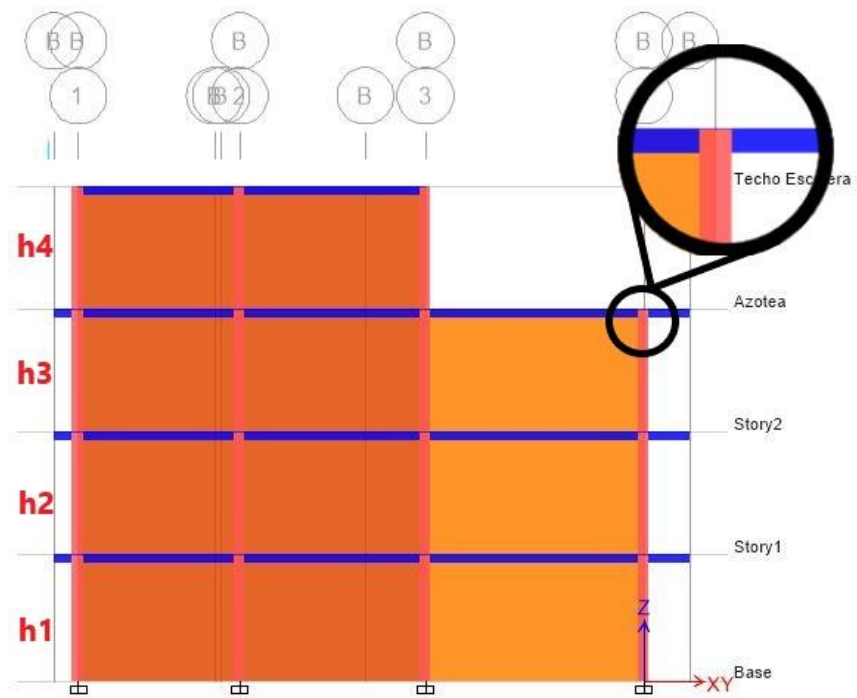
ETABS - Ubicación de Vigas Modeladas bajo el Eje de Entrepiso.
